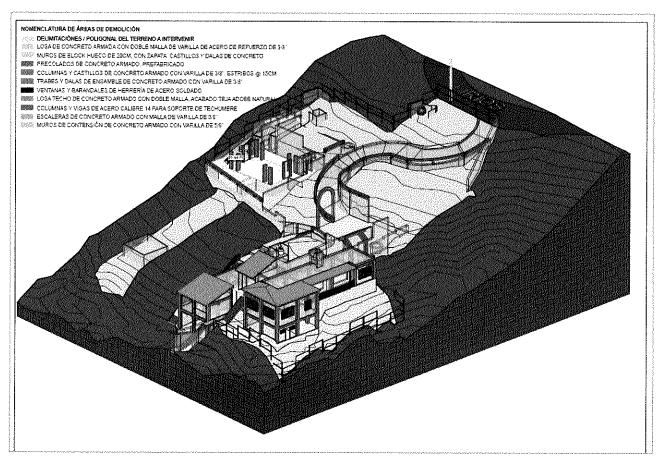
Plano general de las obras a demoler. Fuente: Topográfico.
